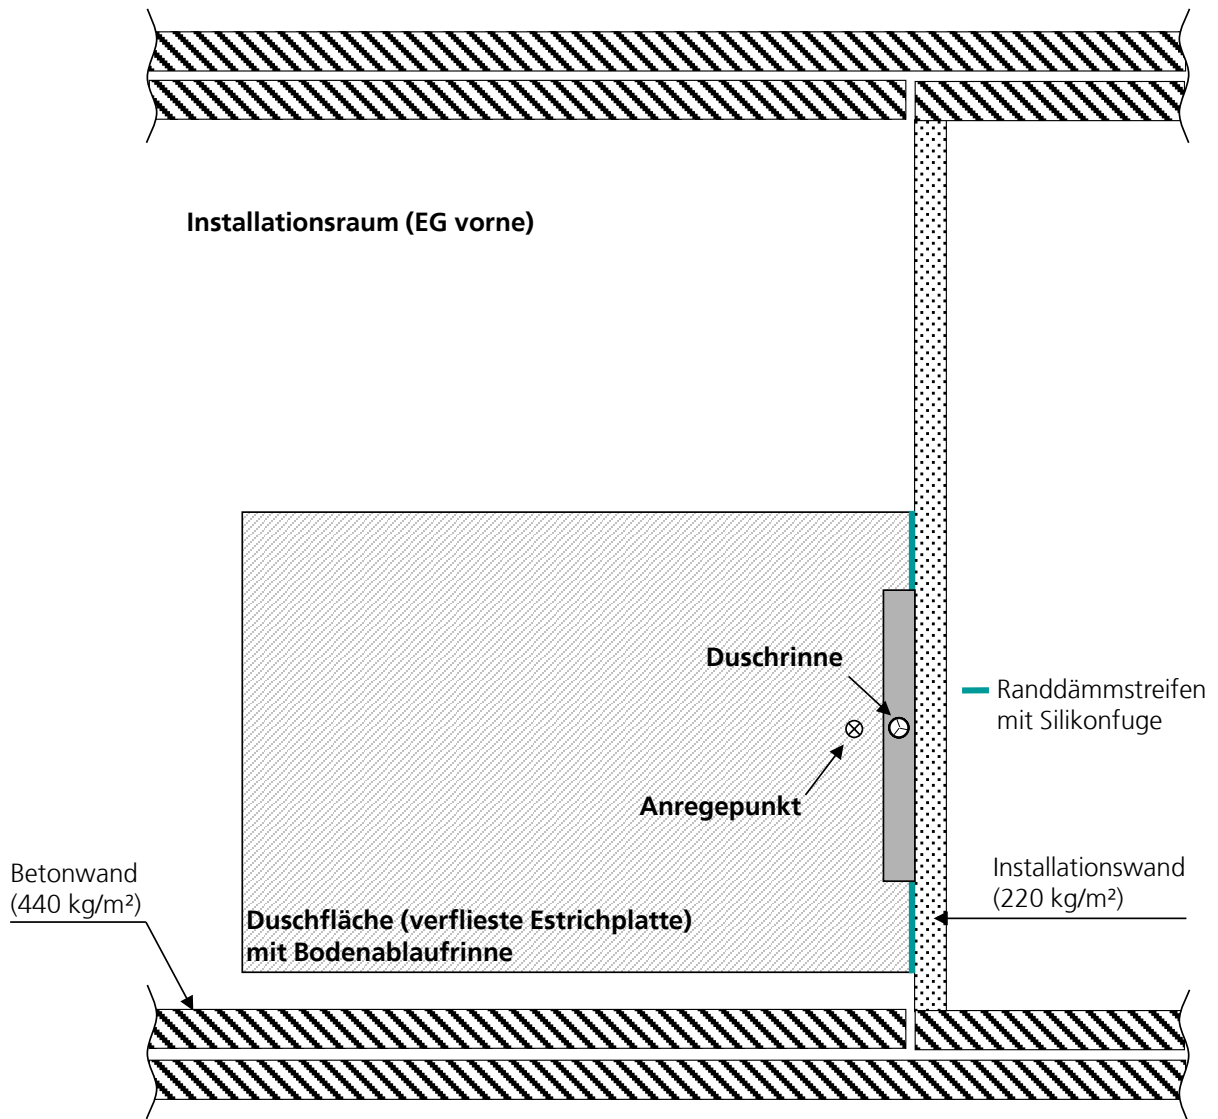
Lage der Duschfläche mit Bodenablaufrinne im Installationsraum (EG vorne).
